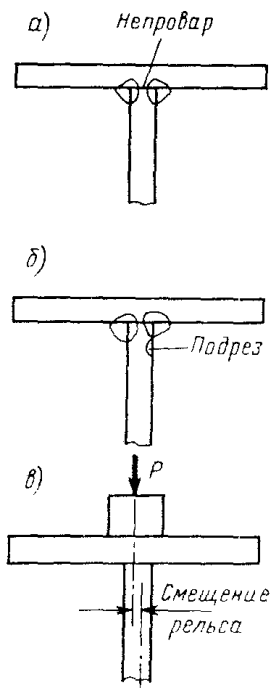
Требования к соединению полки подкрановой балки со стенкой
